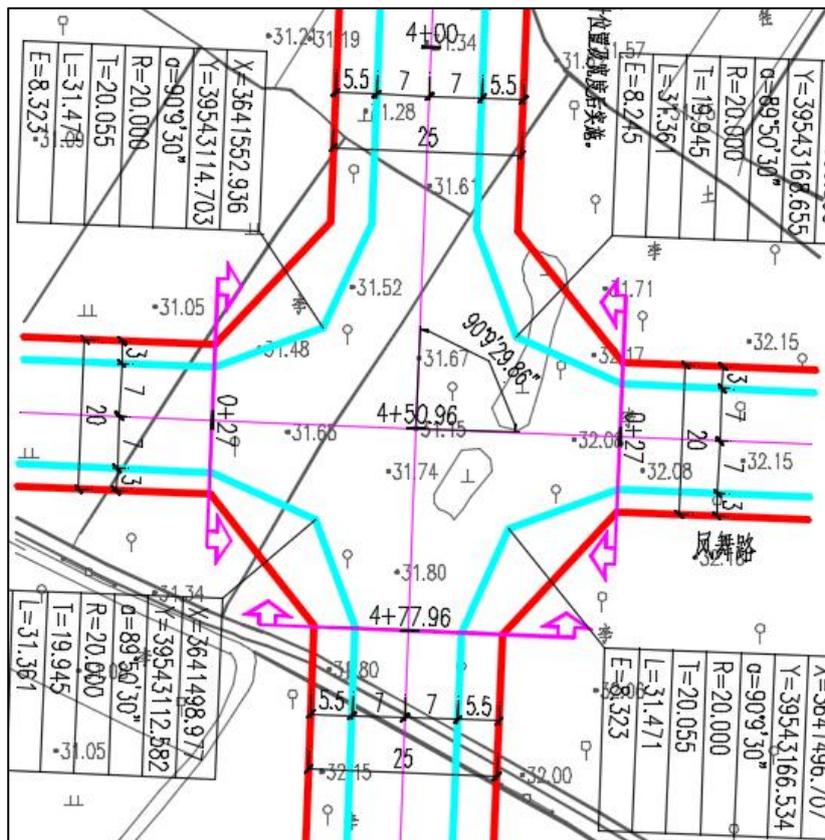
风舞路与龙秀路交叉口交通组织平面图
